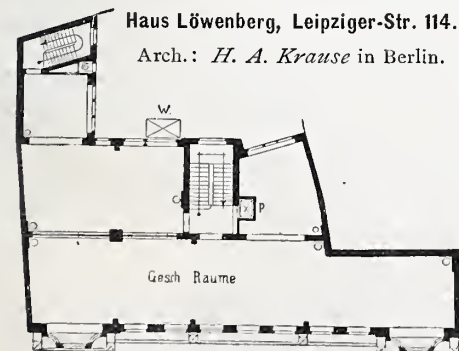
Grundriss vom II. Obergeschoss 1:500.
